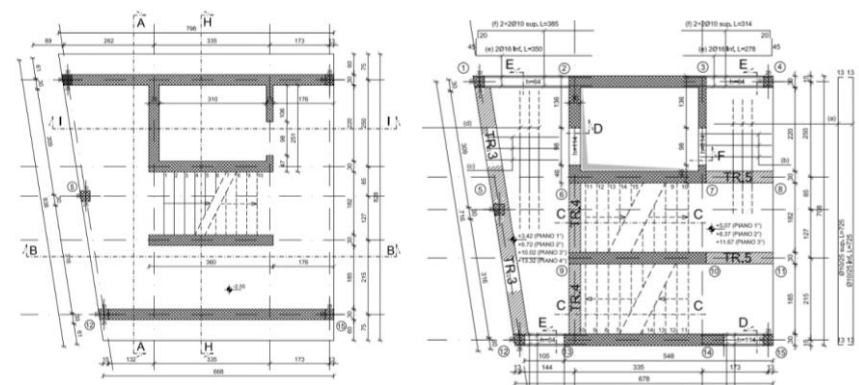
Pianta fondazioni (sinistra) e piano tipo (destra) corpo C
